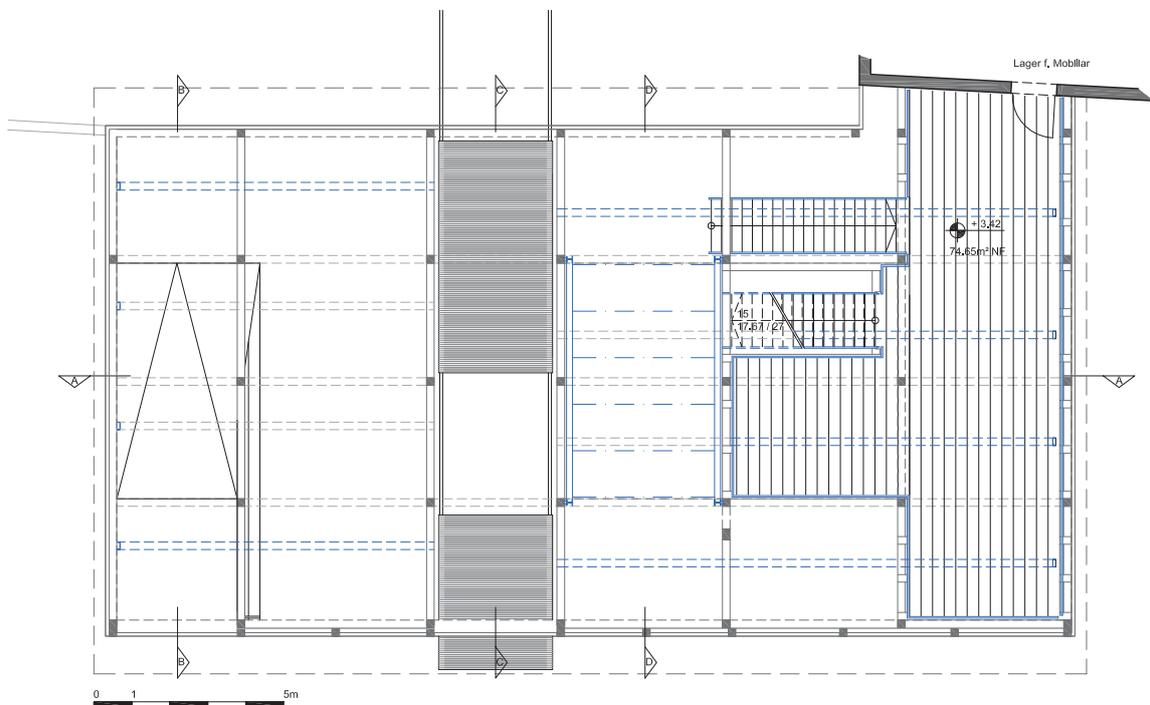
, Grundriss Ebene +3.42 M 1 : 200
